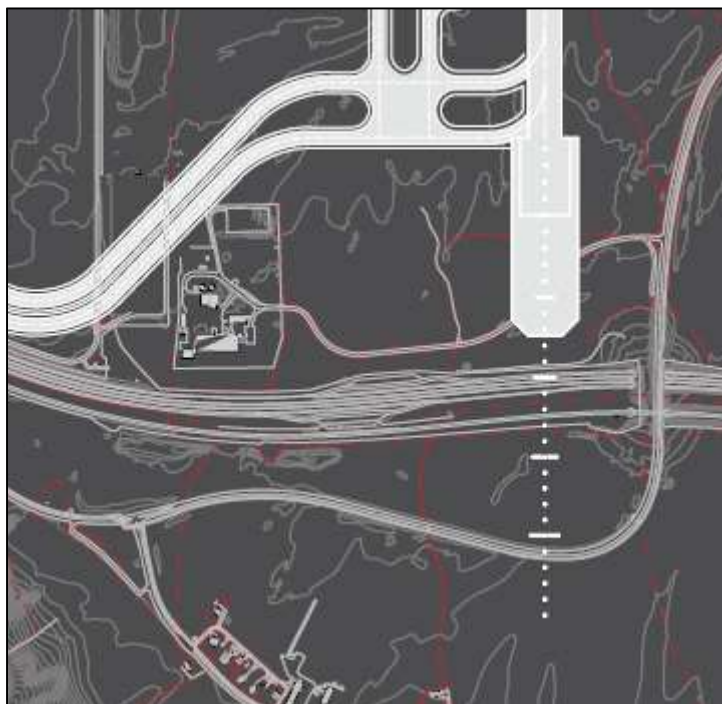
Gjeldende reguleringsplan. Det er gjort en planendring i 1996 for å flytte adkomstveien slik at planen nå følger Rensevegen.
